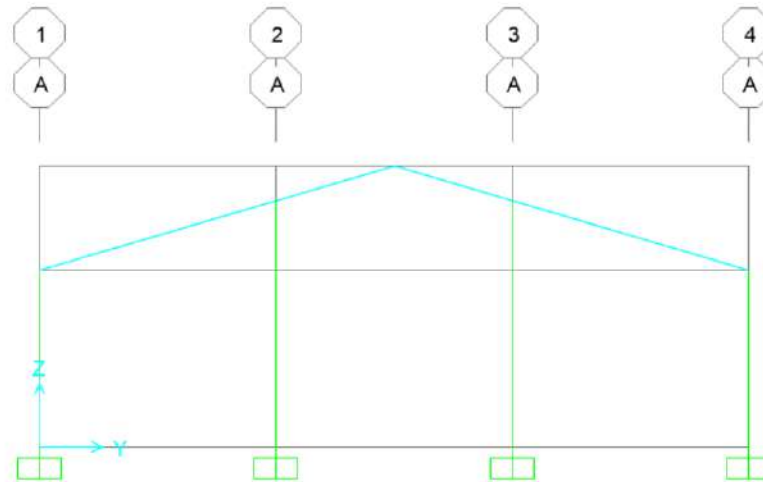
Pemodelan Struktur Tampak Perspektif Samping Kiri
